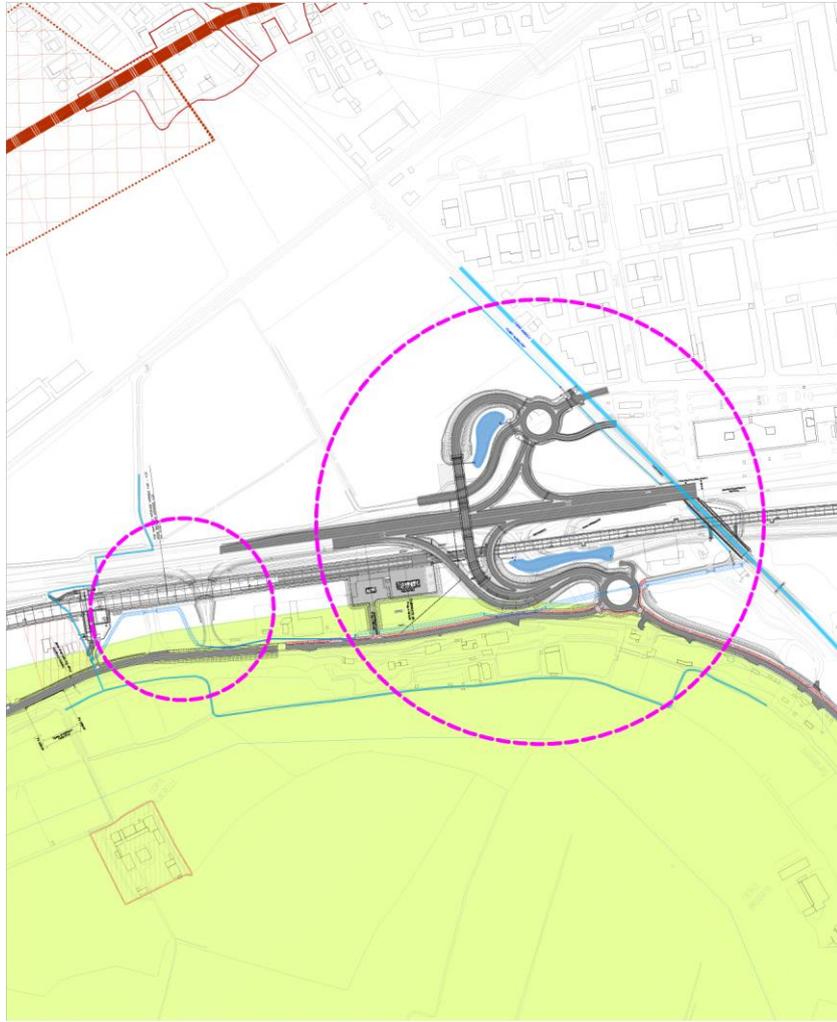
bis- Stralcio Carta dei vincoli Tav. 1/8, con individuazione delle aree interessate dalle opere di PD
